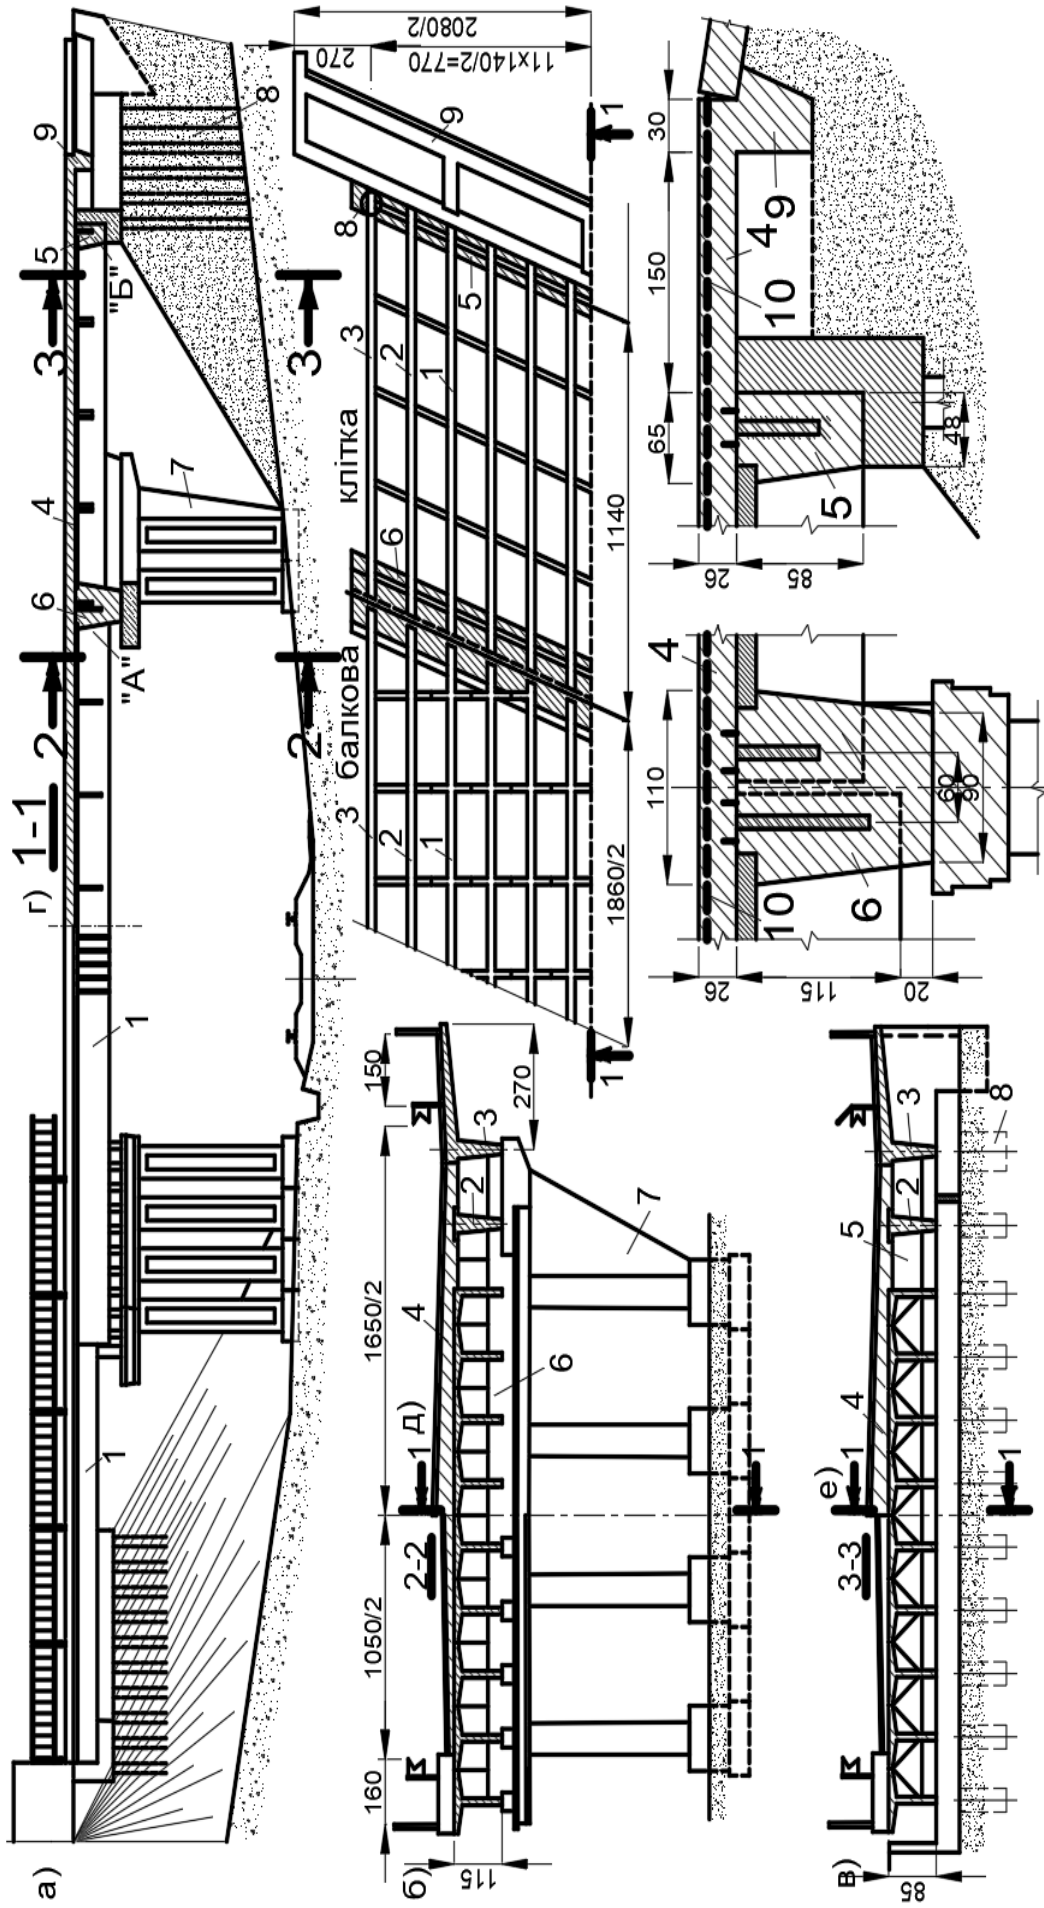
Конструкція існуючого (а, б, в) і реконструйованого (г, д, е) шляхопроводу. 1 – існуючі балки; 2 – замінена крайня балка; 3 – добудована балка; 4 – монолітна залізобетонна накладна плита; 5,6 – надпорні ребра над береговими і проміжними опорами; 7 – підкос розширення проміжної опори; 8 – добетонована насадка і бурунабівна паля берегової опори; 9 – поперечне ребро, 10 – проектне положення надпорної робочої арматури
